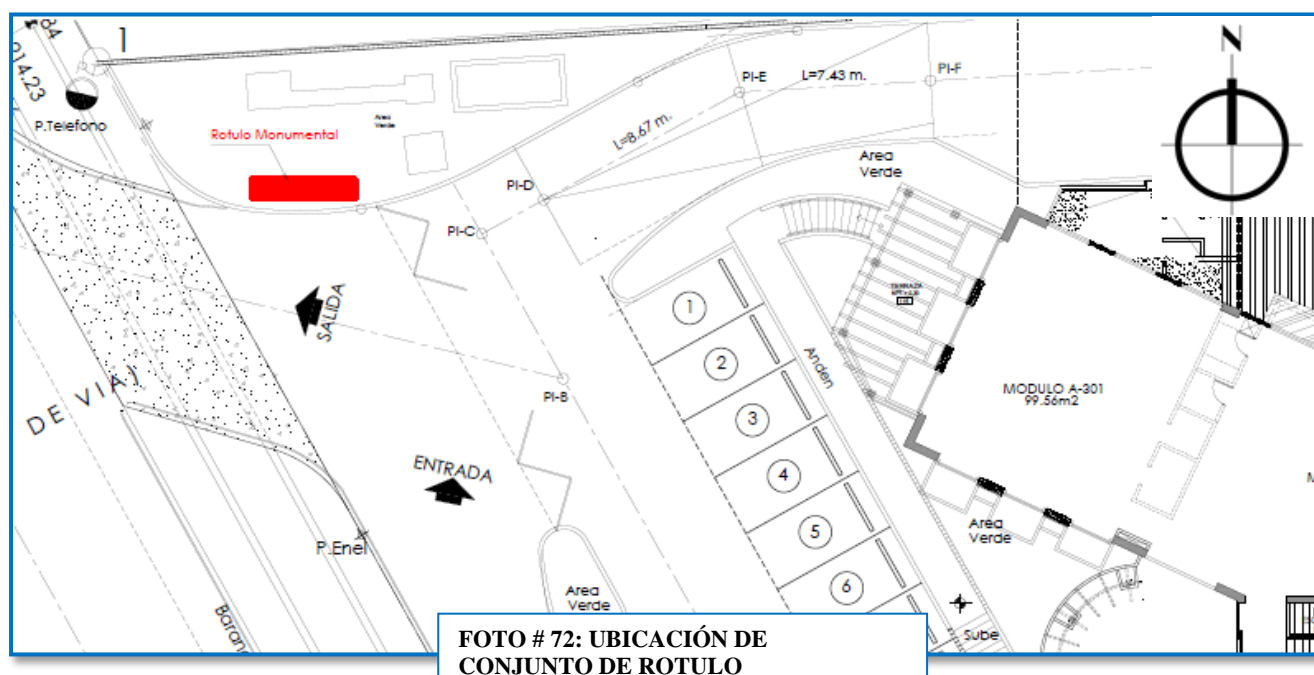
UBICACIÓN DE CONJUNTO DE ROTULO
